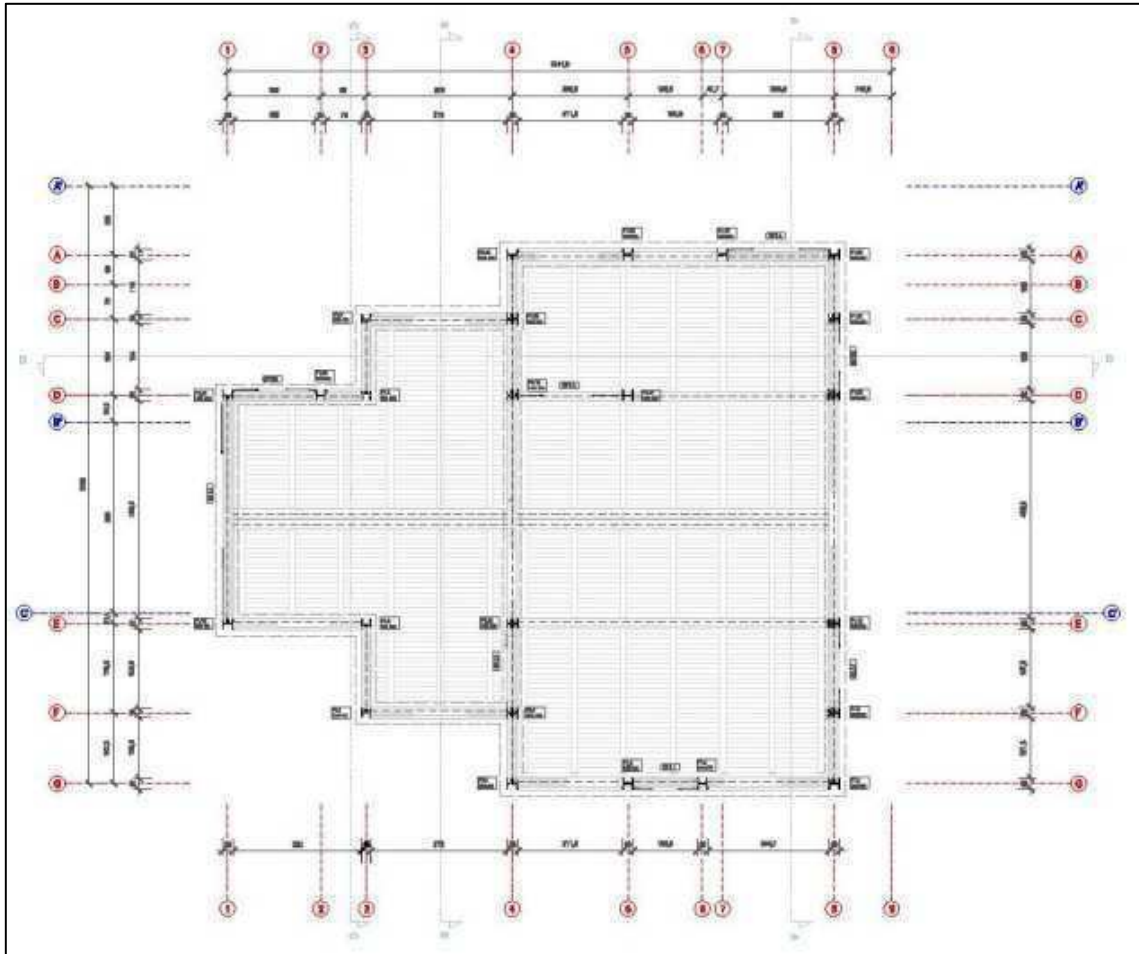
Pianta Piano Terra Pilastri; Tavola 15.
